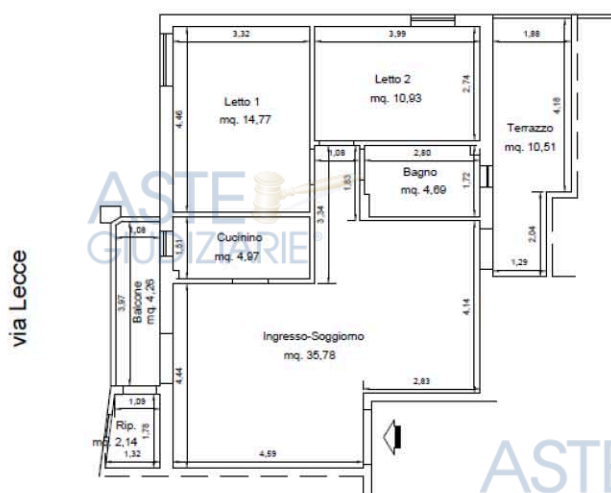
Planimetria rilevata dell'appartamento - non in scala
